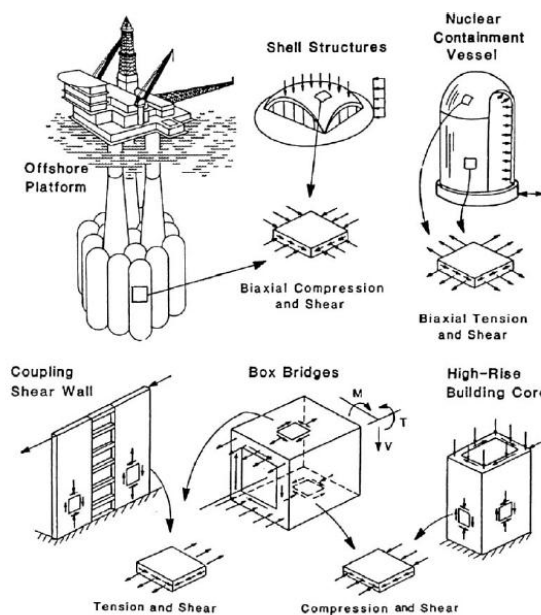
Simplificação de estruturas de betão armado em elementos do tipo placa [1].
